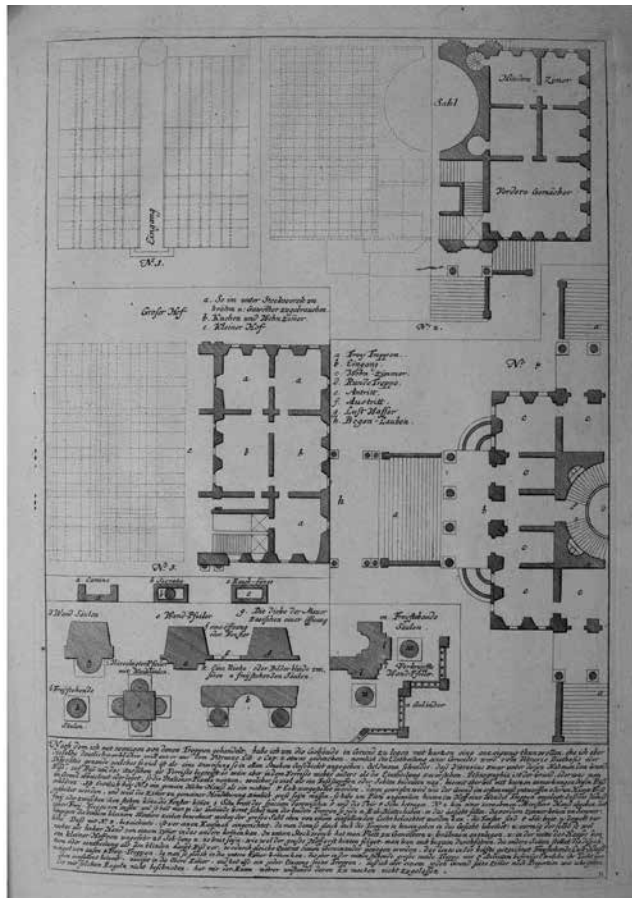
Planta y sección de un palacio. Fuente: Decker (1715).
